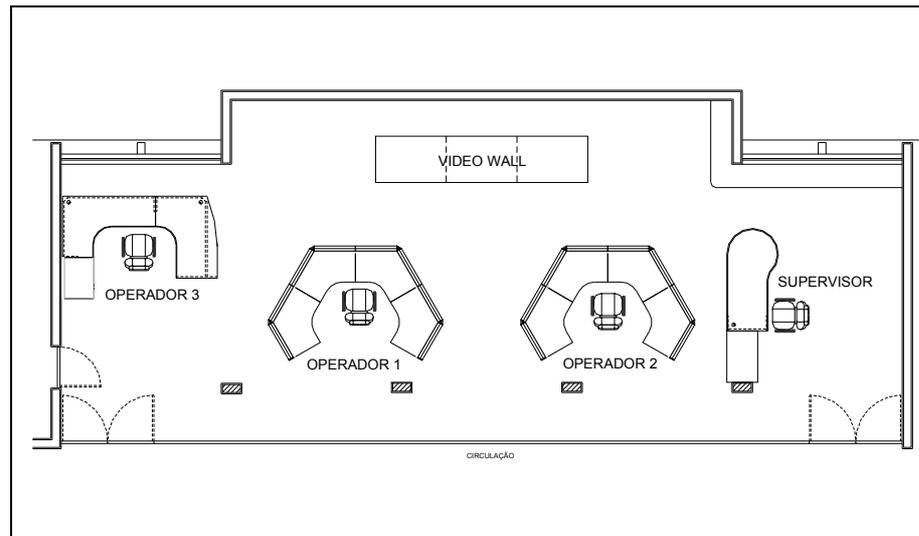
Planta baixa da sala de controle com a localização dos postos de trabalho.
